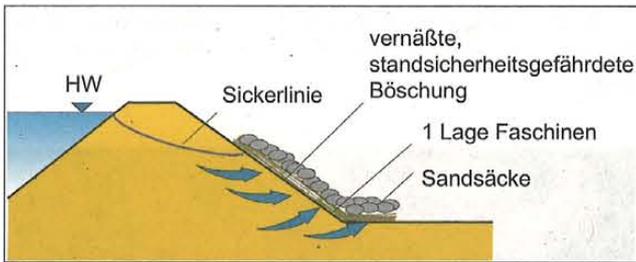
Stabilisierung einer aufgeweichten Böschung mittels Sandsacklagen auf Faschinenunterbau – Prinzipskizze
